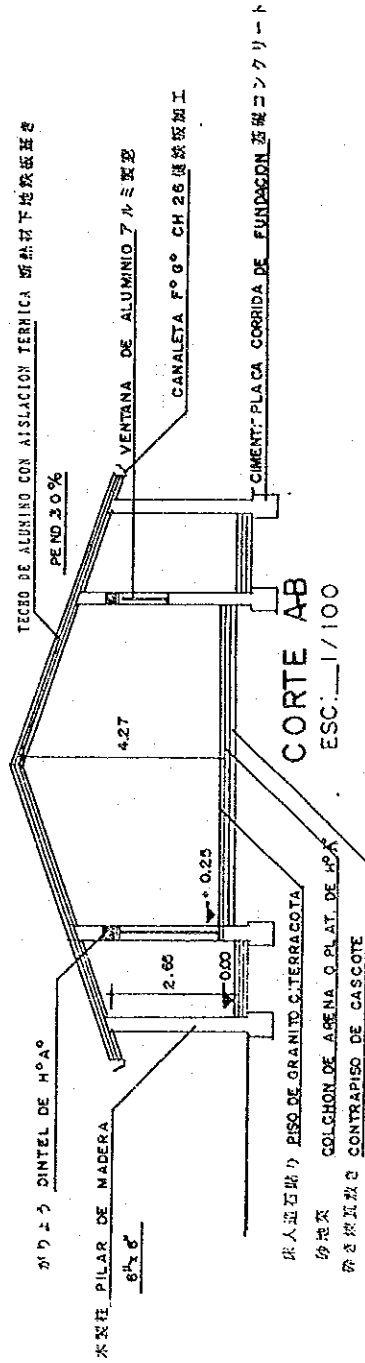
(2) PLANO (EDIFICIO DE ADMINISTRACION Y ENTRENAMIENTO DE CENTRO DE ENTRENAMIENTO AGROPECUARIO)
